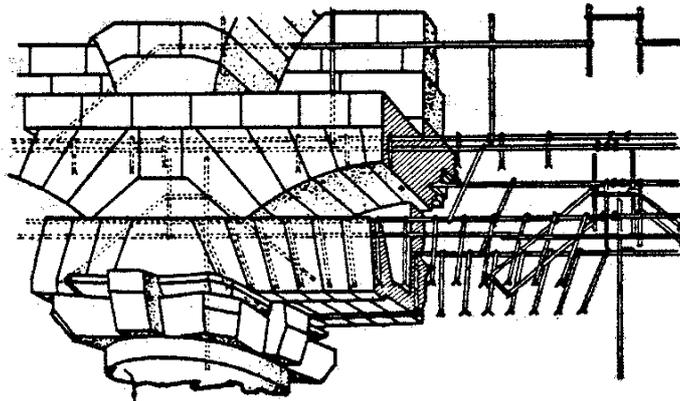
Alvenaria de pedra armada, *Pantheon* de Paris
